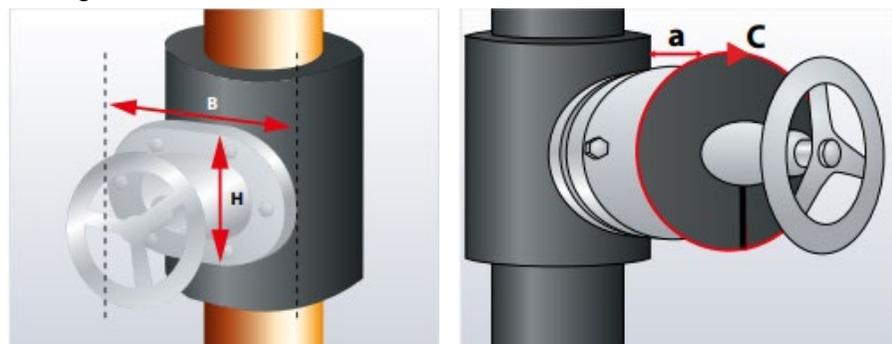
Massnahmen der Ventilschnecke mit Plattenmaterial
